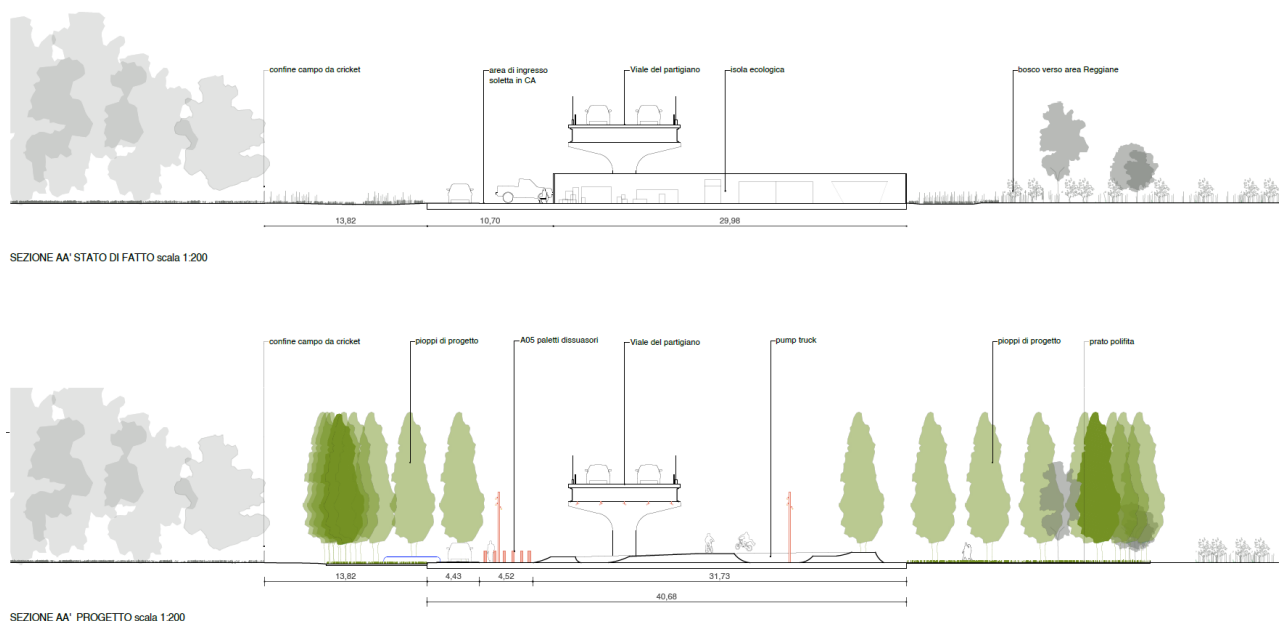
Sezioni dello stato di fatto e di progetto sull'area di ingresso
